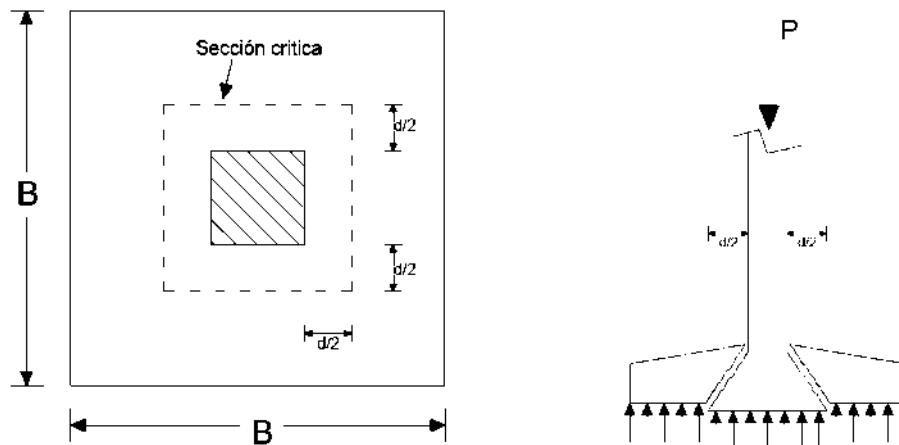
(f) Vista en planta y alzado de la sección crítica
